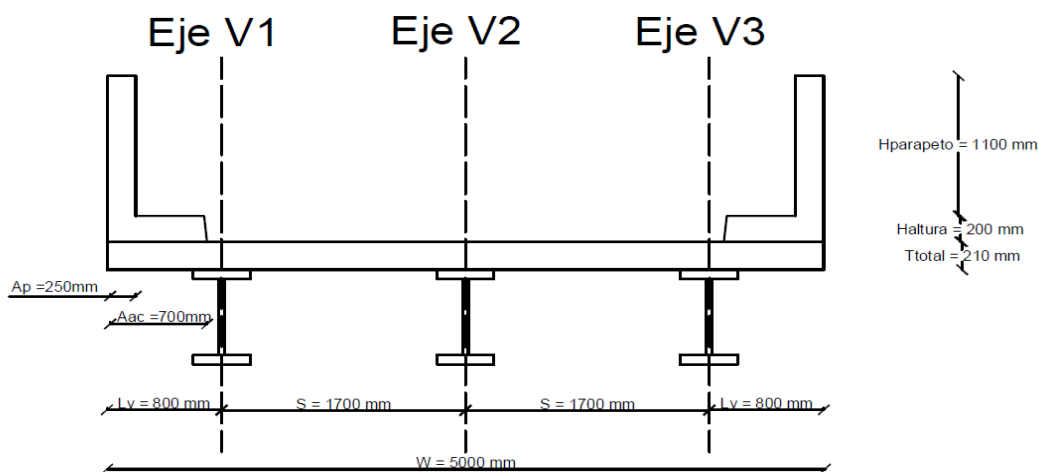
Sección transversal de la superestructura del puente. Elaborado por: Autor
